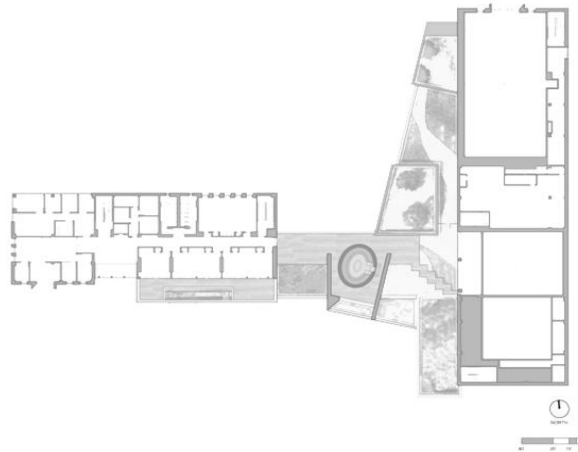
Planta Segundo Nivel (Student Activity Center) | Fuente: ArchDaily
